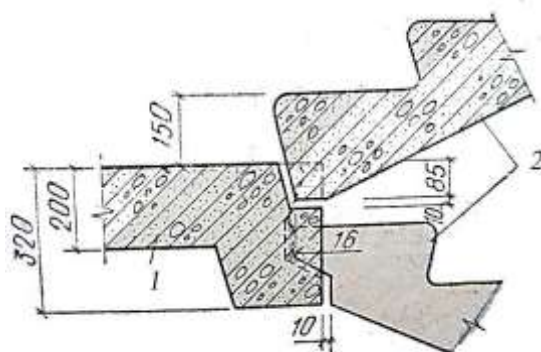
Узел сборной железобетонной лестницы. 1-Лестничная площадка, 2-Лестничный марш
